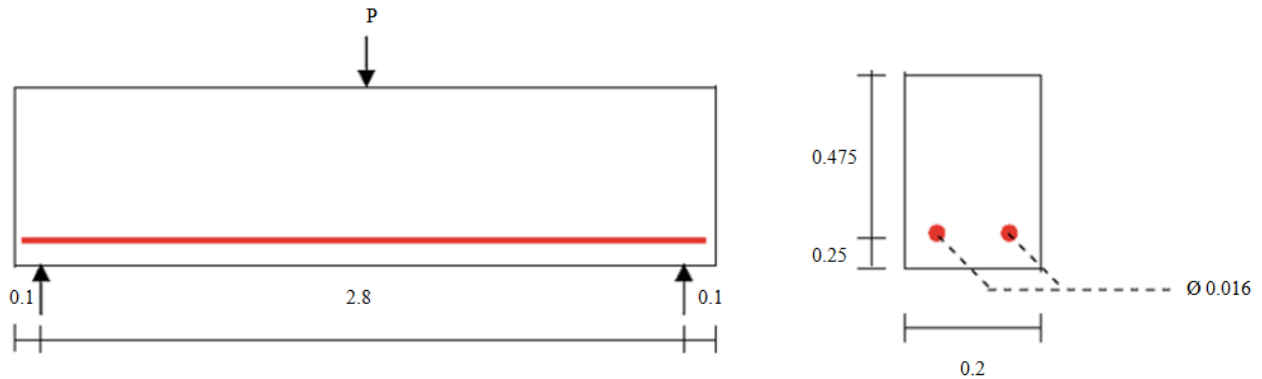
Géométrie de la poutre et des barres d'acier (dimensions en mètres)
